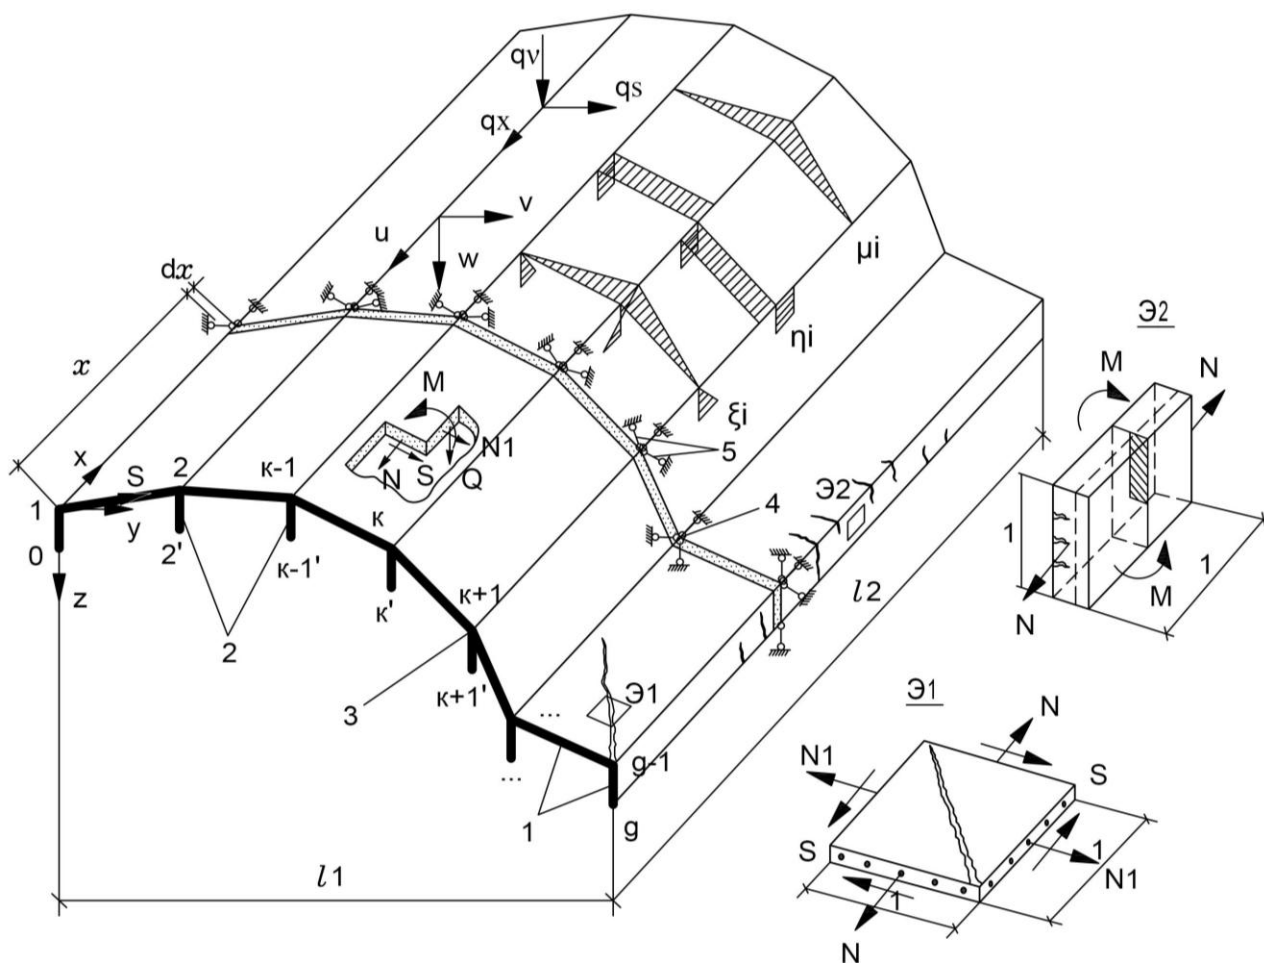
Расчетная схема железобетонной складки: 1 – основные грани; 2 – дополнительные грани; 3 – цилиндрические шарниры
